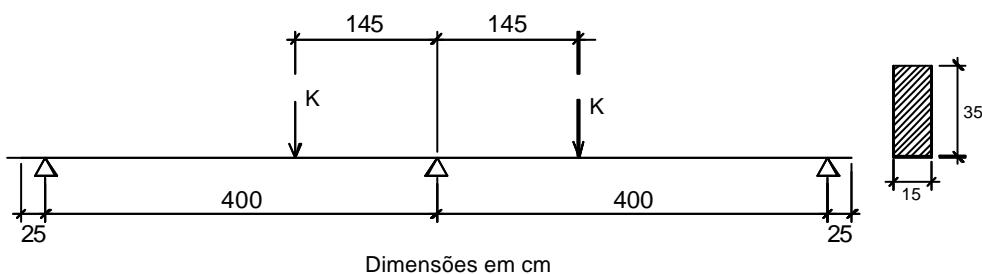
Esquema estrutural da viga do exemplo 3
